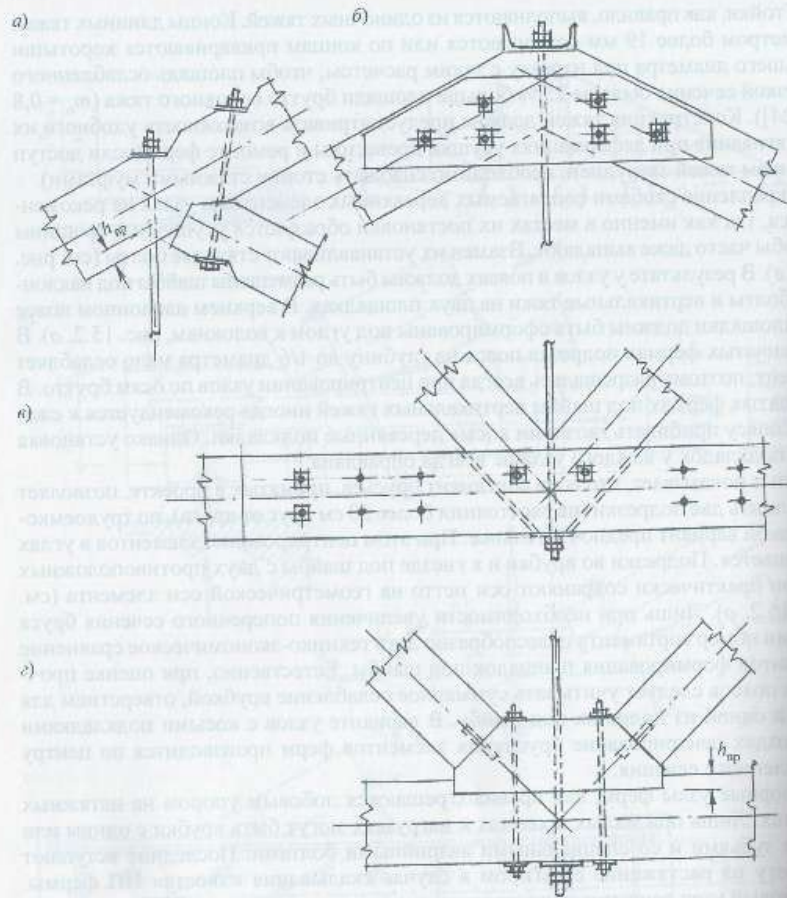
Узлы треугольных ферм на врубках: а – промежуточный узел ВП; б – средний узел НП; в, г – варианты среднего узла нижнего пояса
